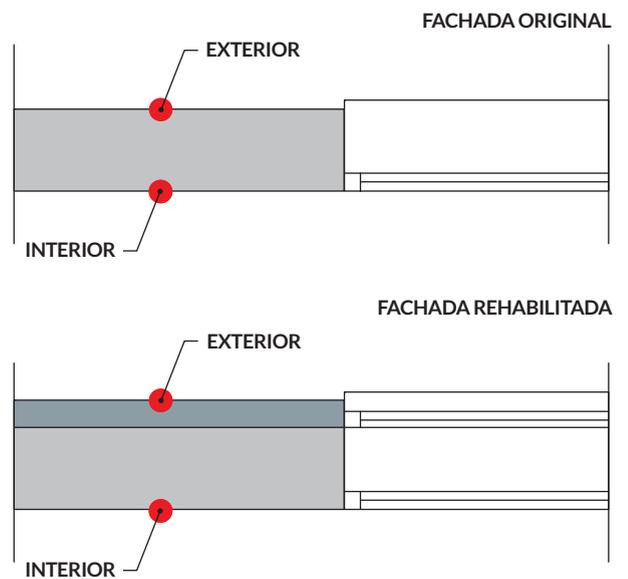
sección horizontal de las fachadas tipo y esquema colocación termopares en las fachadas
